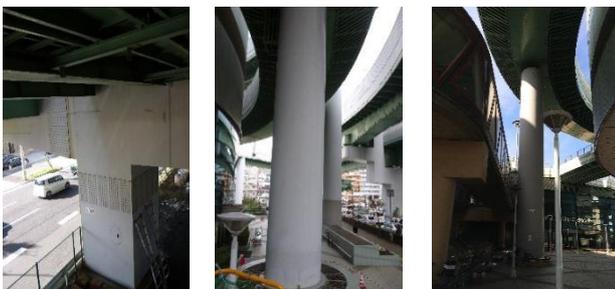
橋脚 A 写真-2 橋脚 B 写真-3 橋脚 C
